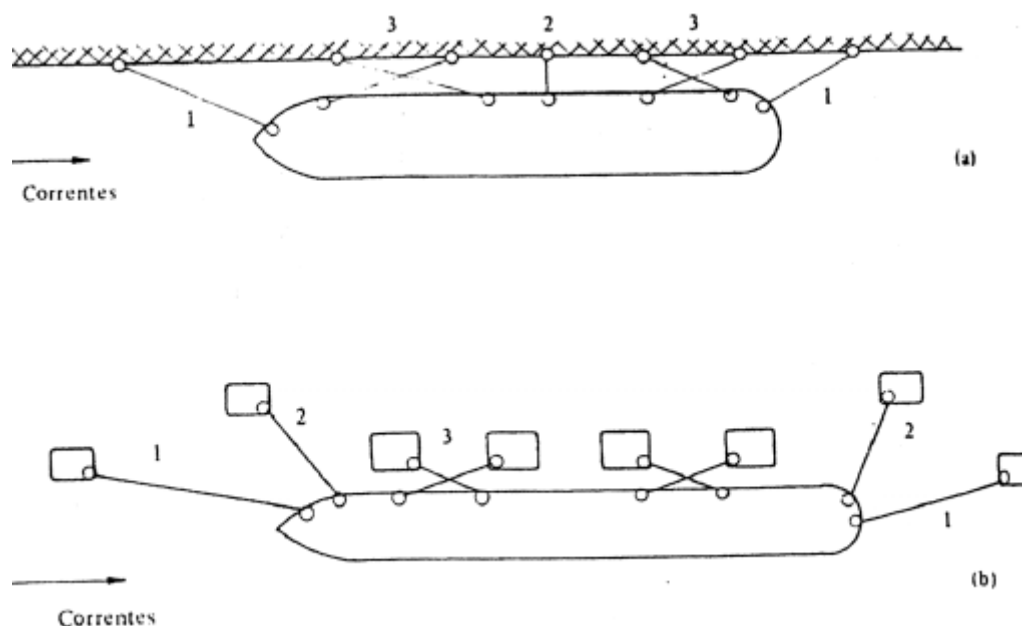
Arranjo de amarração do navio ao cais. Fonte: Mason (1987)
